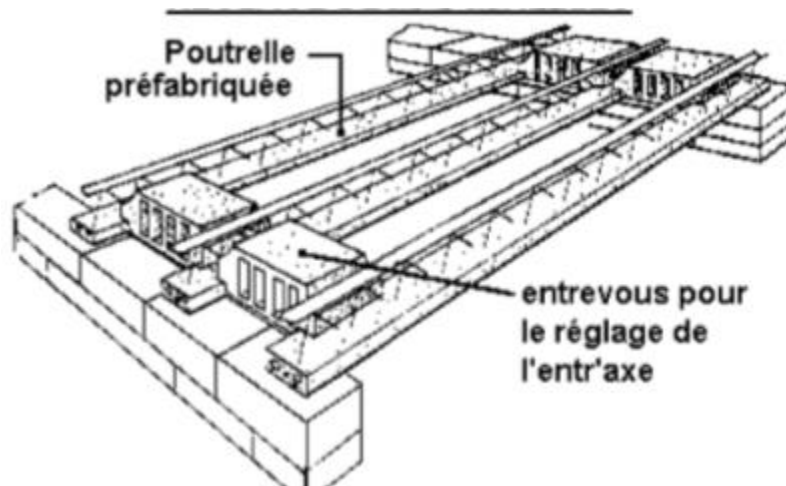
plancher à corps creux à poutrelles préfabriquées
